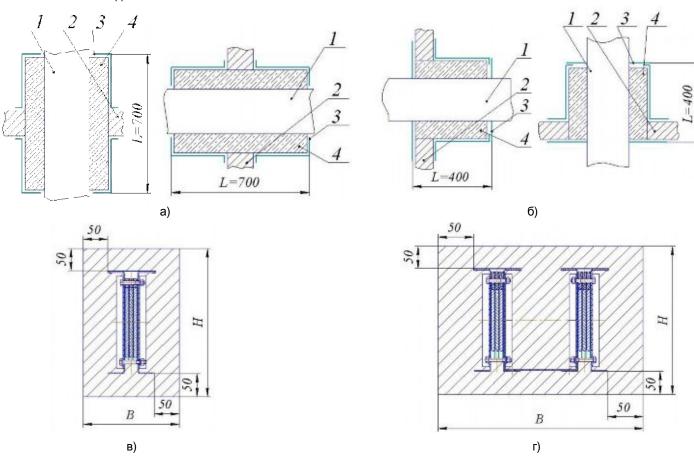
Крепление для вертикальной установки и крепление напольное
